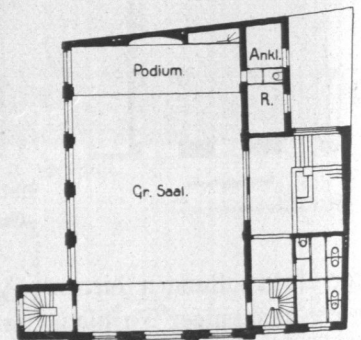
Volksheim Billhorner Mühlenweg, zweites Obergeschoß, Grundriß.
